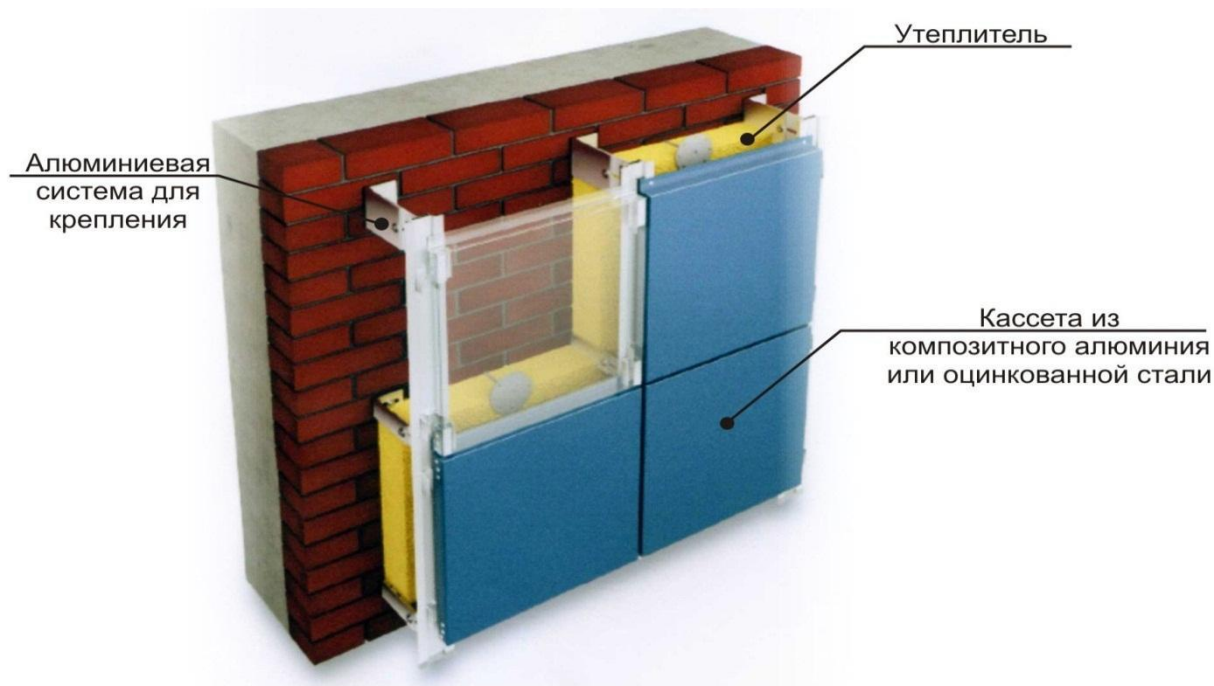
Схема возведения конструкции вентилируемого фасада
